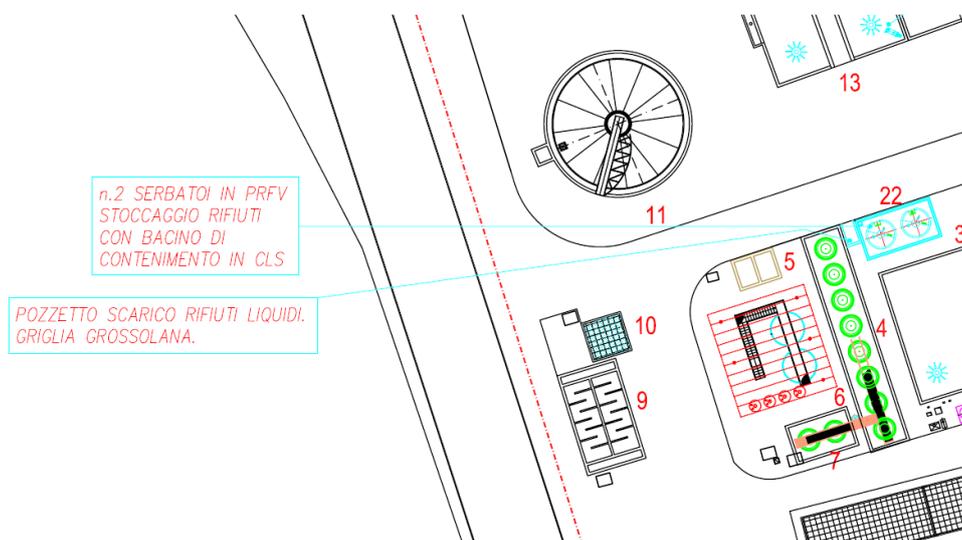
stralcio planimetrico nuovi serbatoi di stoccaggio e area di scarico
